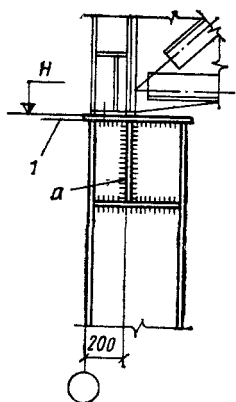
Оголовок колонны крайнего ряда бескранового здания при нулевой привязке
